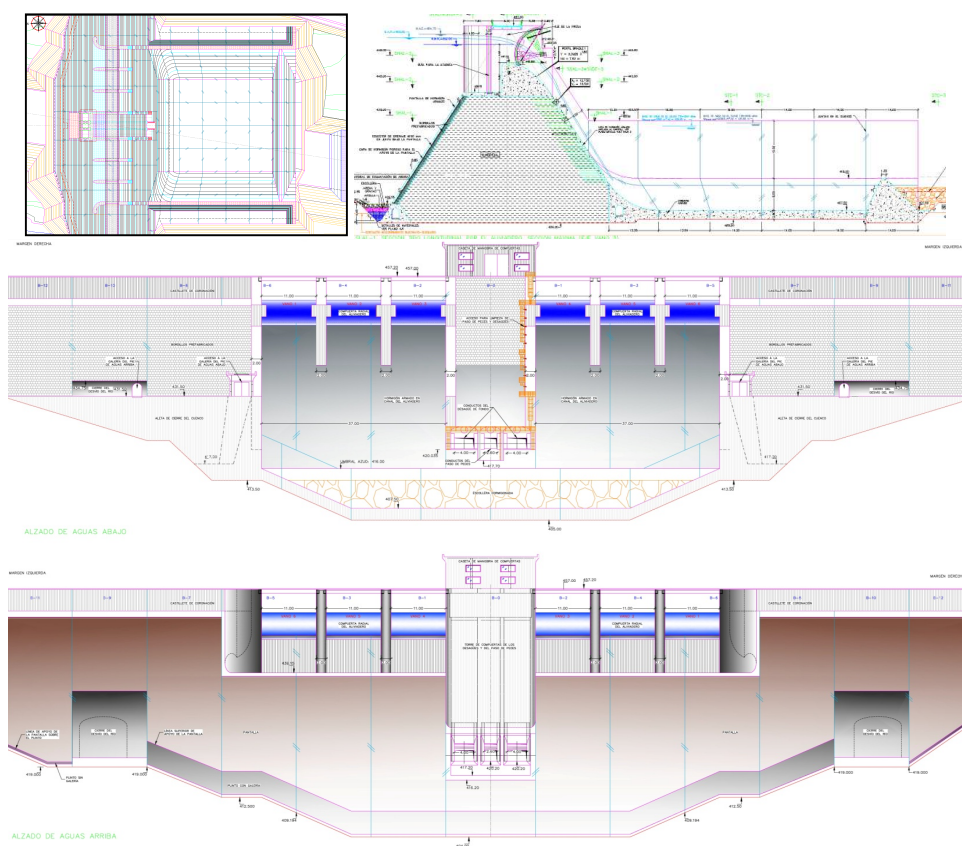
Aliviadero. Planta, longitudinal y alzados.
